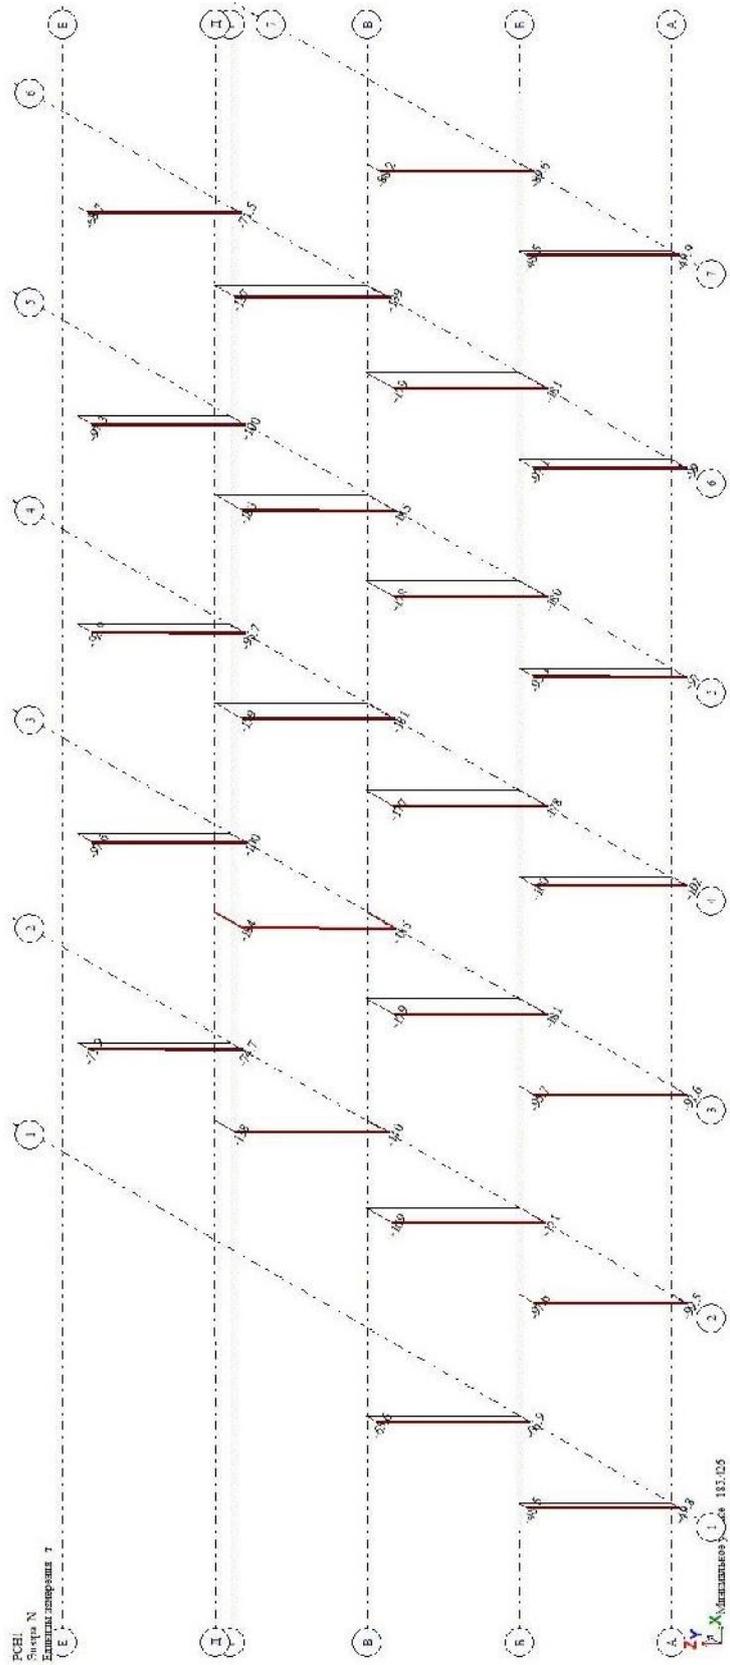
Схема нагрузок N на фундаменты АБК
